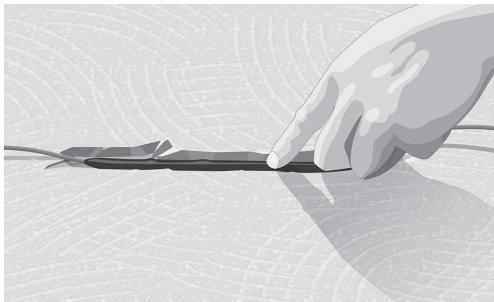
Штроба для соединения нагревательного кабеля и соединительного провода
